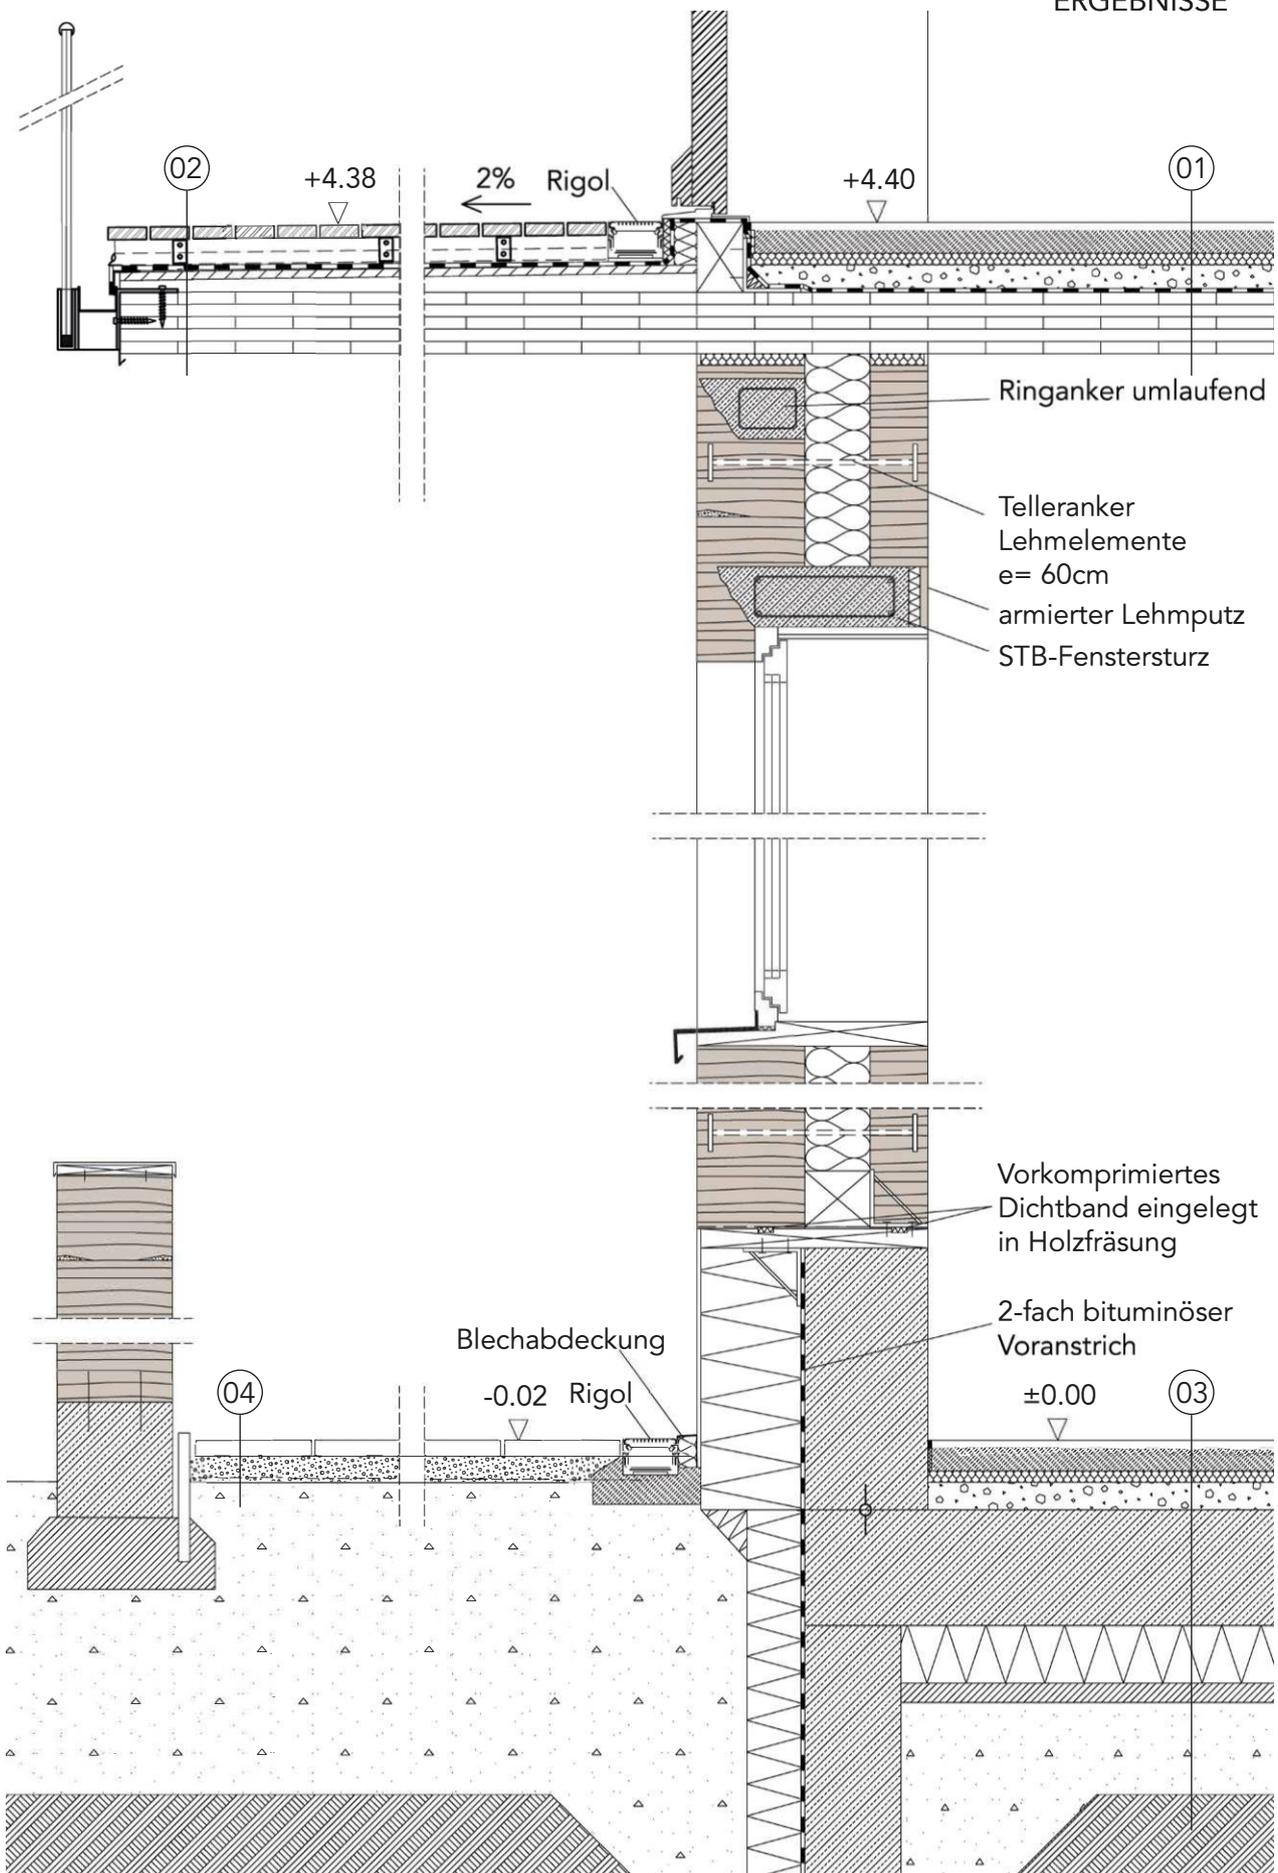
Konstruktionsdetail 1, Lehmaußenwand
